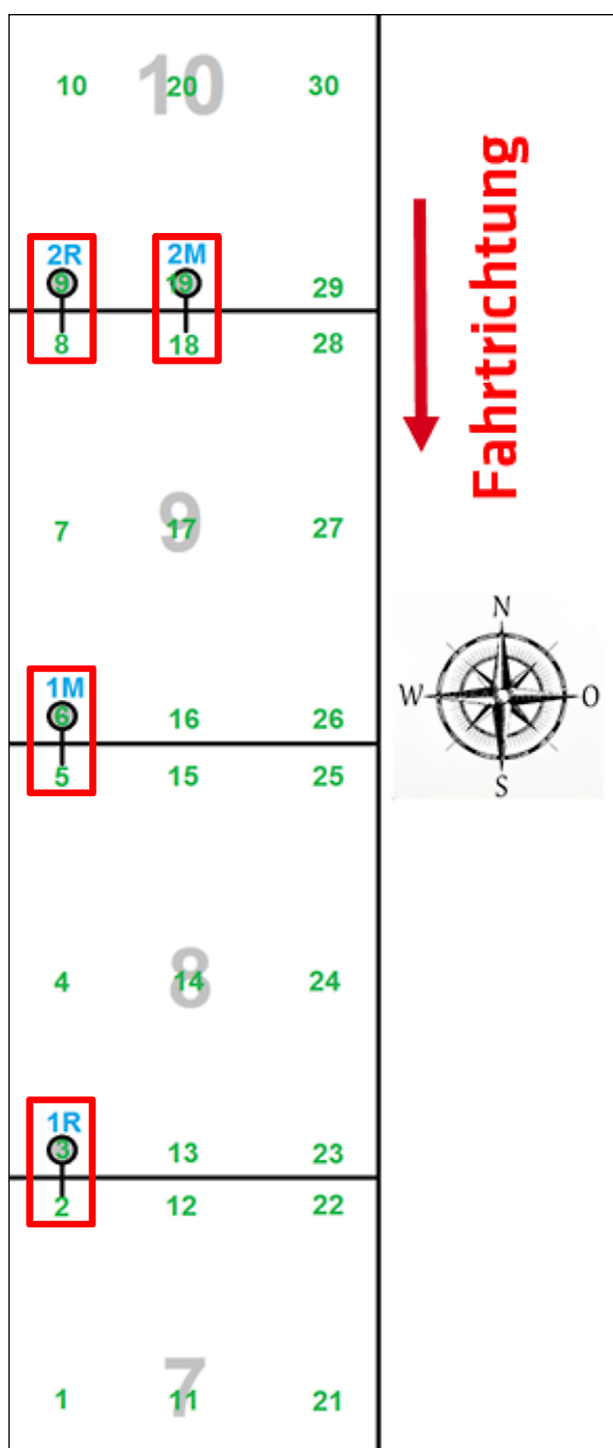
Lageplan der 30 FWD-Messpunkte auf der Waschbetonstrecke 40 des duraBAST mit eingezeichneten zusätzlich ausgewerteten Messpunkten
